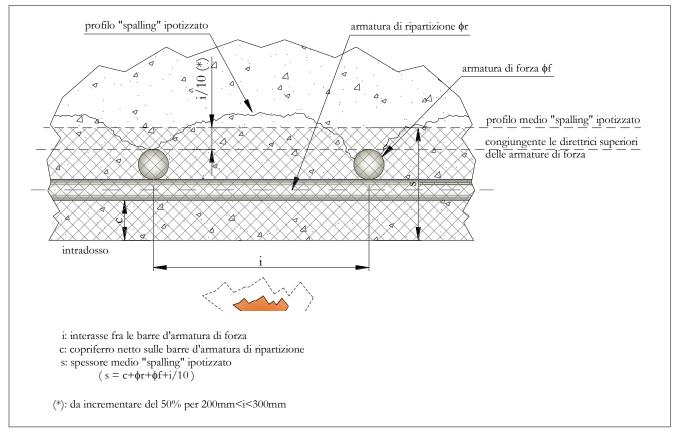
Stralcio schematico sezione strutturale per quantificazione fenomeno "spalling" da cfr. rif. [11]
